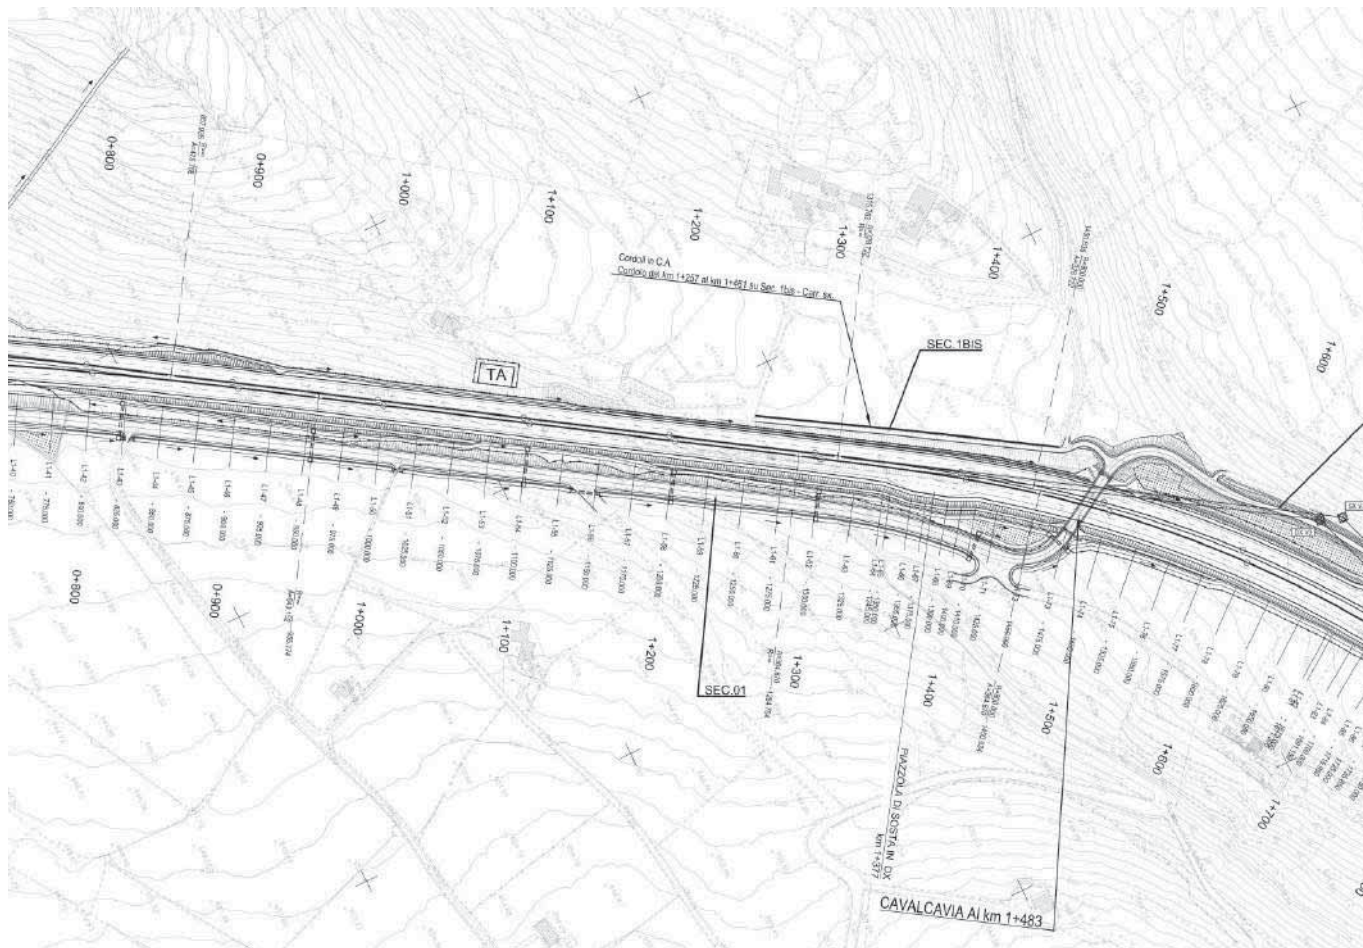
Stralcio planimetrico viabilità sec.01 (Progetto definitivo)
